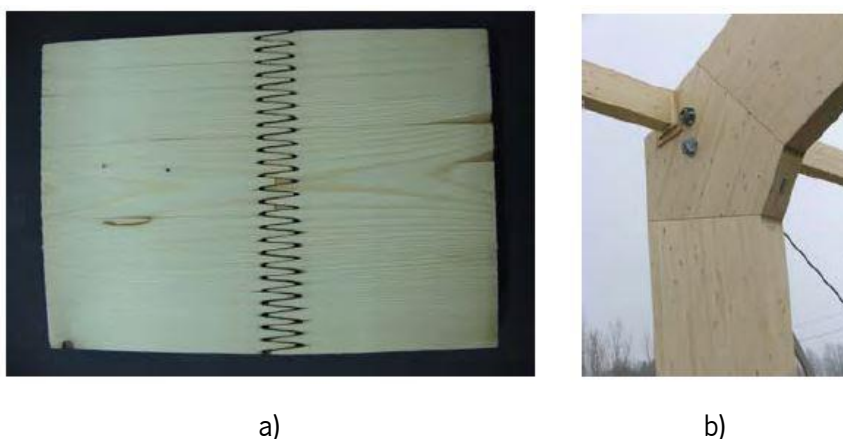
Ligação colada: a) Ligação por “finger-joints” e b) Pórtico de madeira com ligação colada. (Manfred, 2008).
